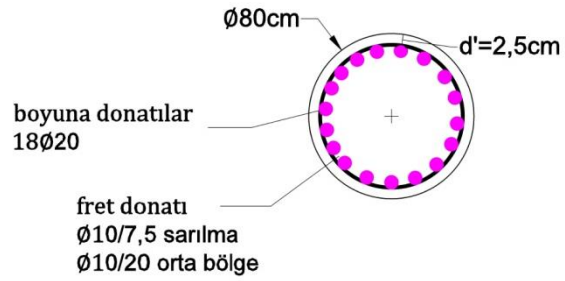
Hesaplanan temel donatısı (Plan görünüş) (Ölçeksiz)
